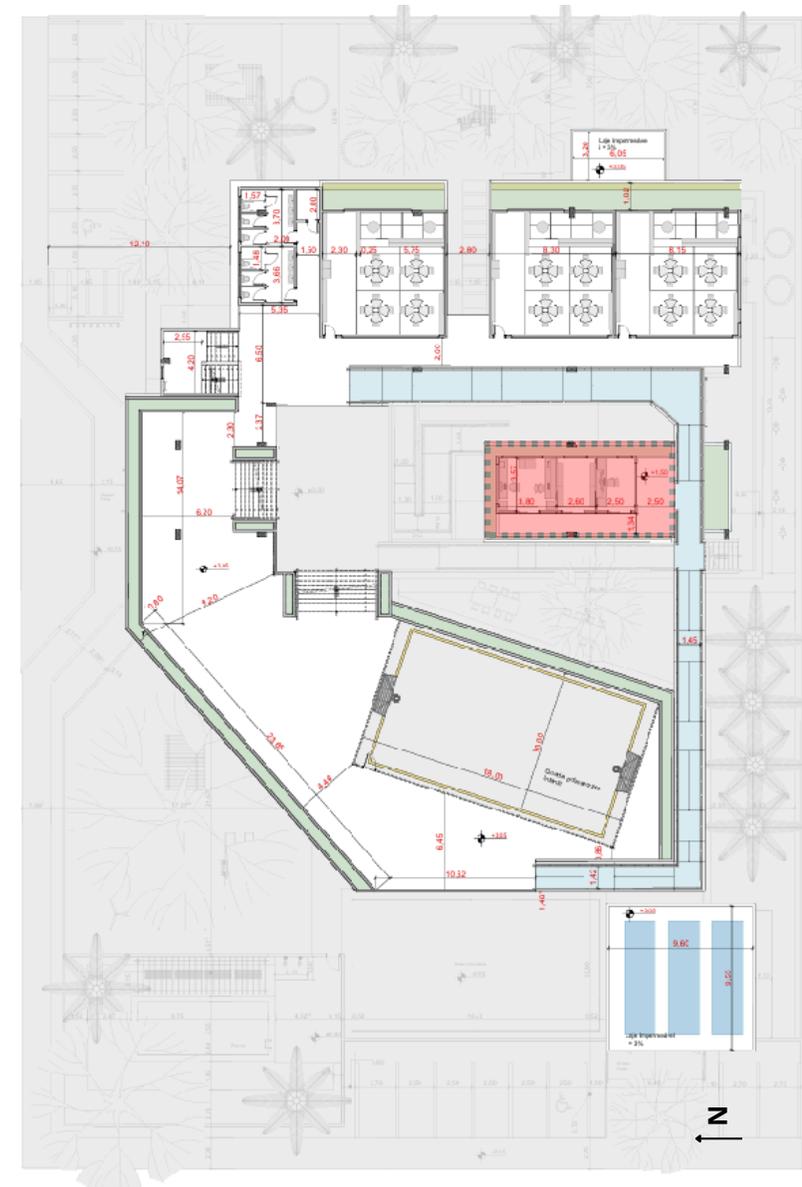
Planta baixa Pavimento Mezanino e Térreo +1
